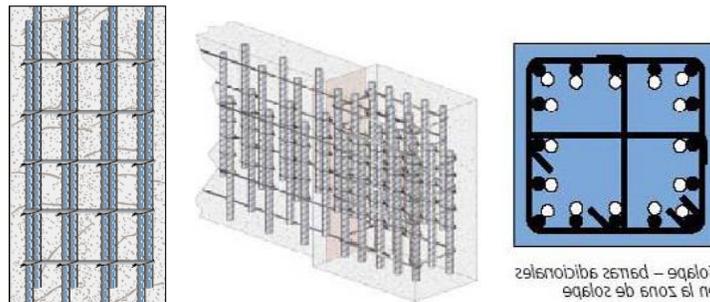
Congestión de armaduras en lugar del empalme traslapado
